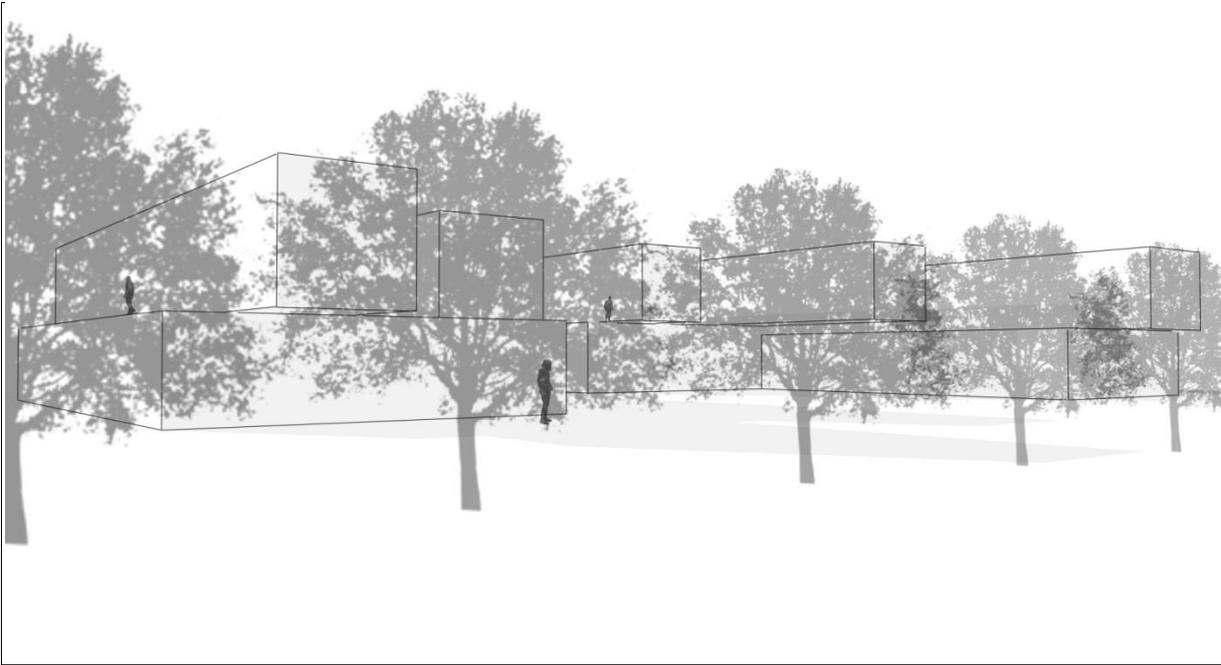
Überlagerung der eingeschossigen Gewerbeflächen mit zweigeschossigen Baukörpern
